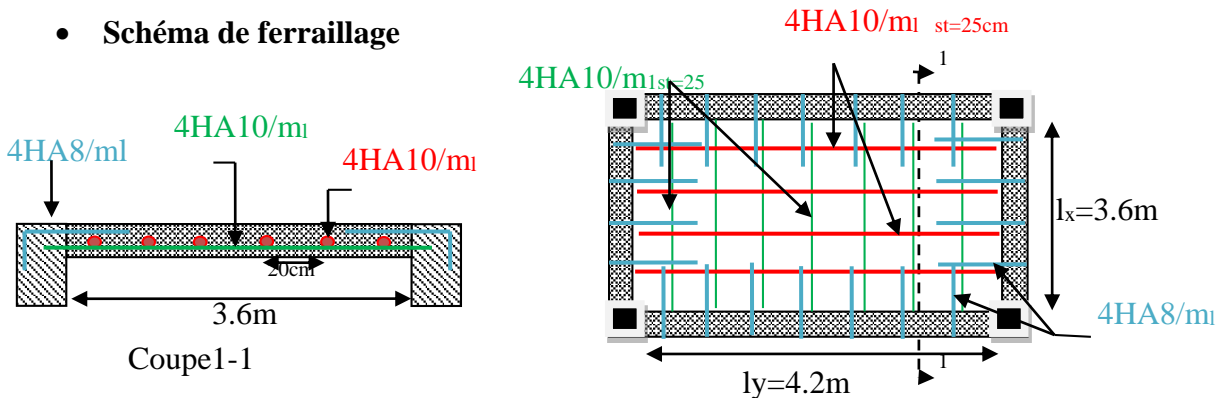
Schéma de ferrailage de la dalle poste transforme.
